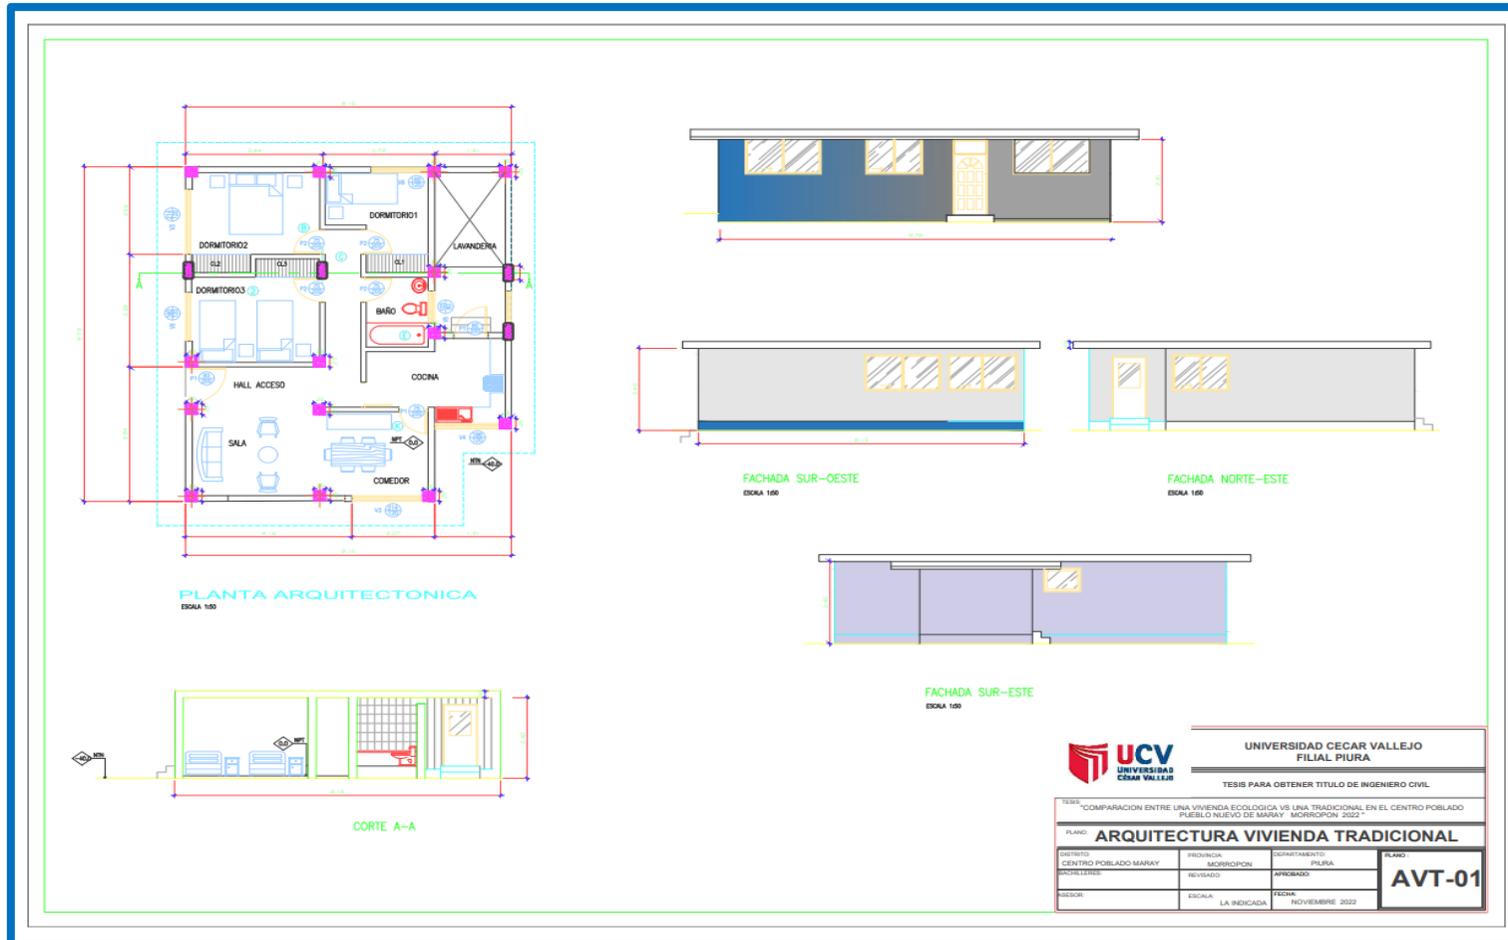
Plano de arquitectura – vivienda tradicional (AVT – 01)
